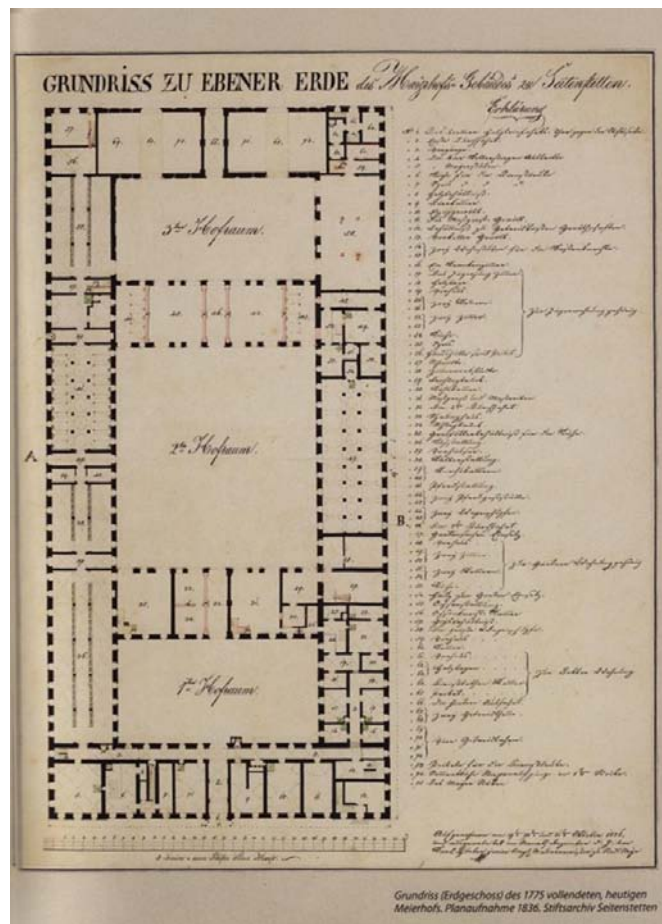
1775 Grundriss des Meierhofes - aus dem Stiftsarchiv
